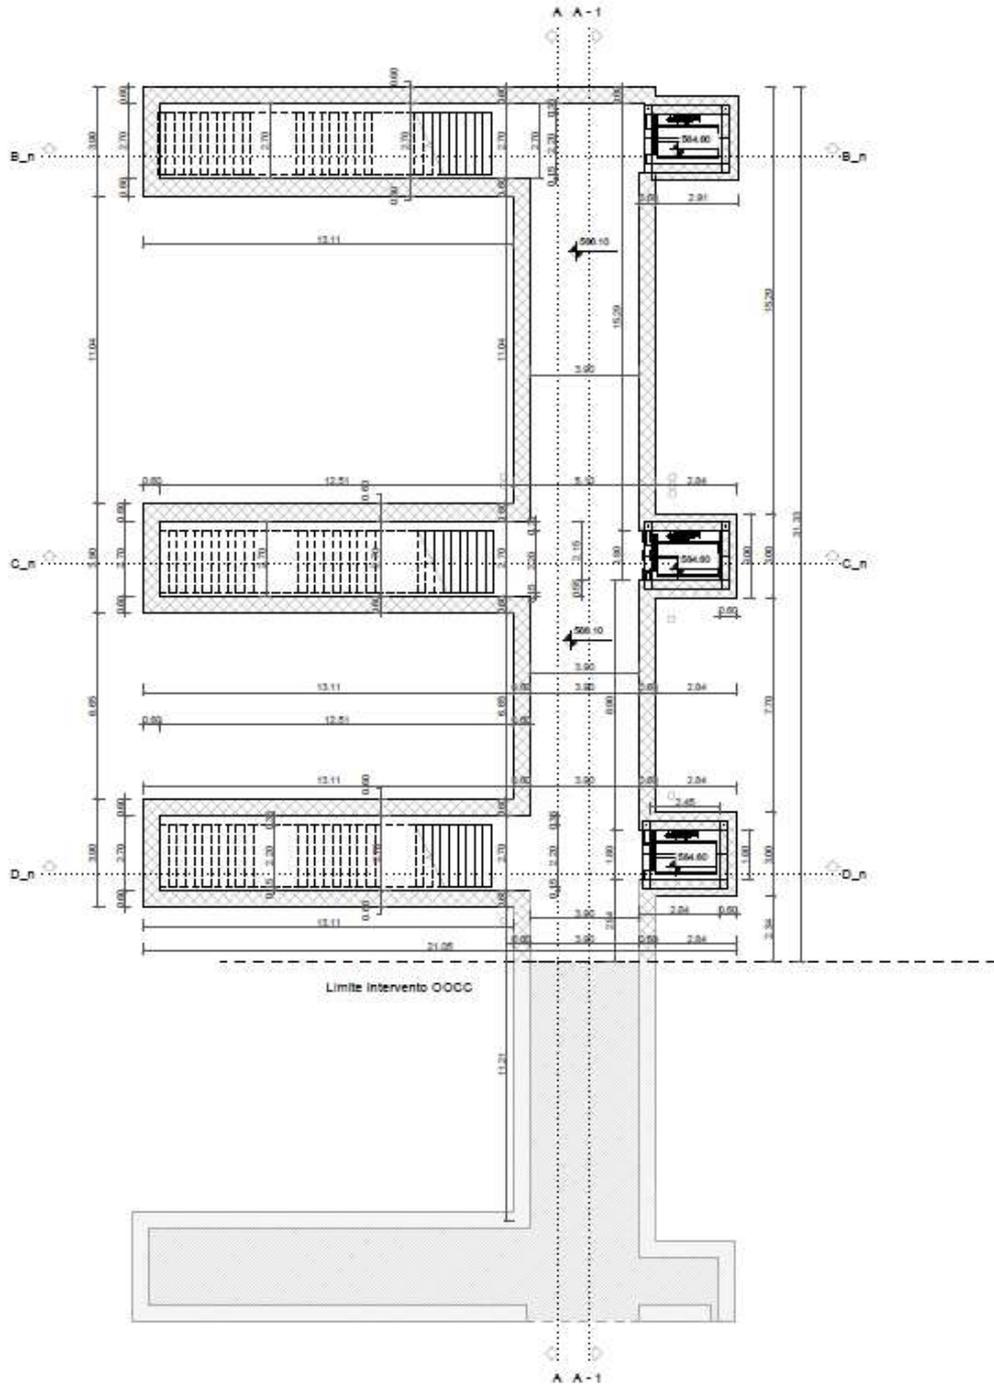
Nuovo sottopasso di stazione SL02 - Pianta
